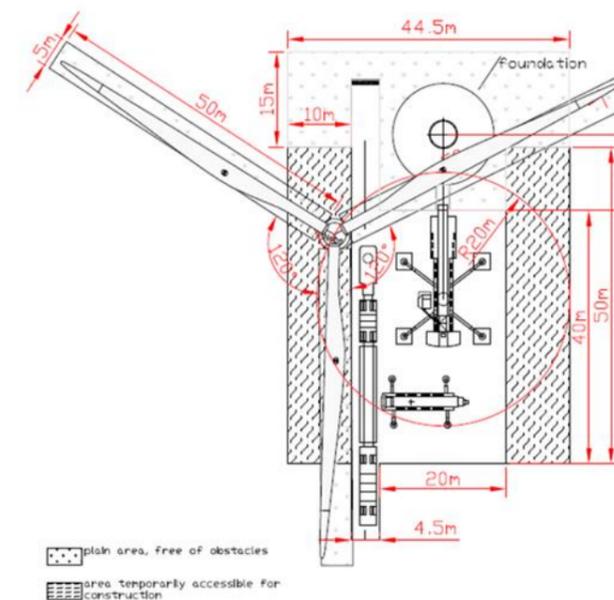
Exemple d'une aire de levage, avec assemblage du rotor au sol
